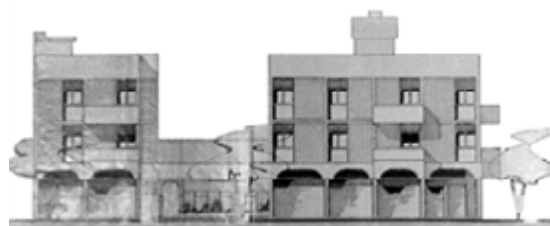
Vista del conjunto desde calle 48. Fuente: Plano original Arq. Nogueira.
